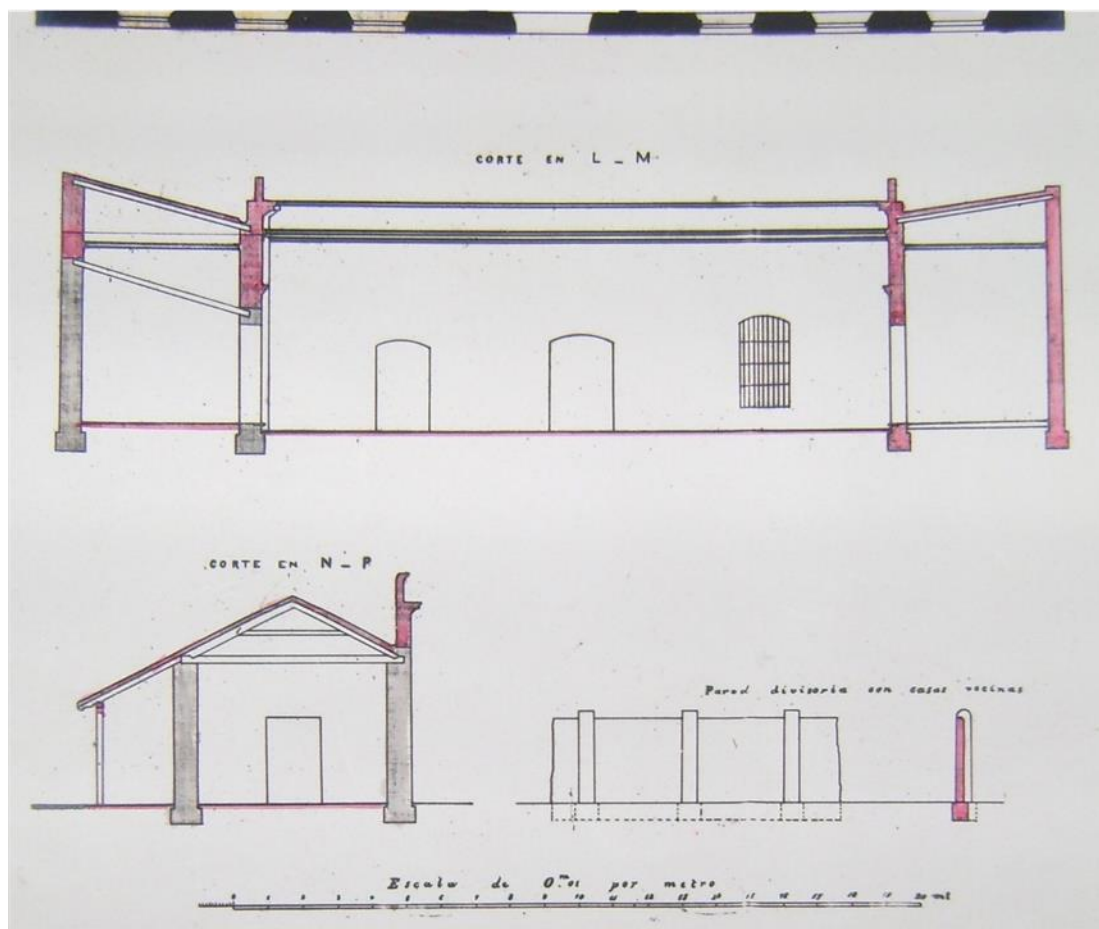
Detalle corte-venta del patio y corte del Salón Histórico. Plano N° 5 BMOP
